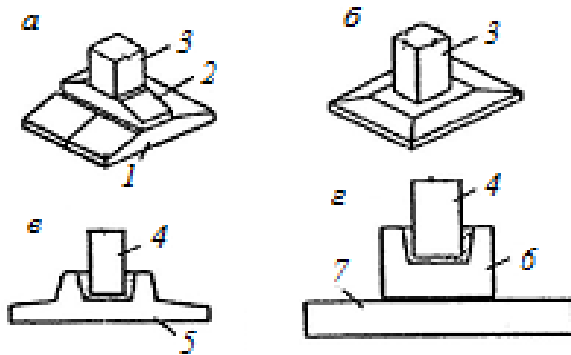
Збірні стовпчасті фундаменти: *а* – під цегляні стовпи з подушок стрічкових фундаментів; *б* – те саме, з залізобетонної плити; *в* – під залізобетонні колони з суцільного залізобетонного блоку-склянки; *г* – те саме, зі складеного блоку; 1, 2 – блоки подушки; 3 – стовп; 4 – колона; 5 – башмак-склянка; 6 – блок-склянка; 7 – залізобетонна фундаментна плита
